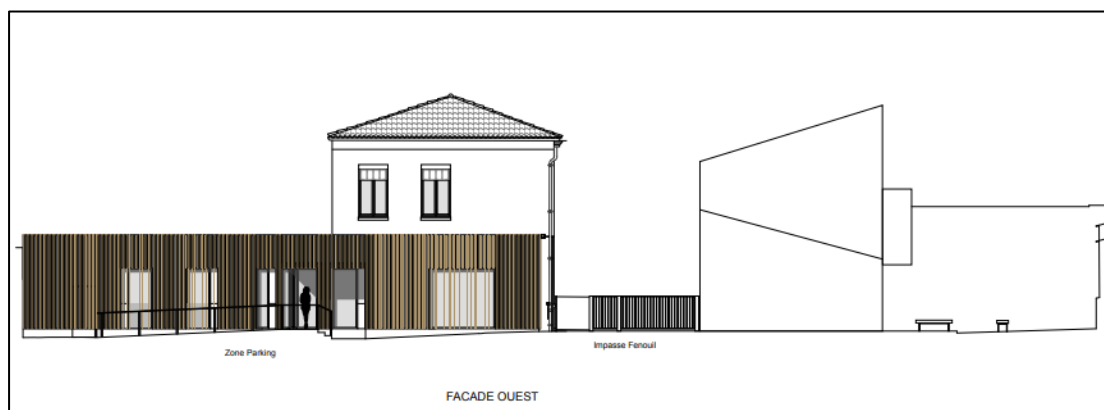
Façade Ouest du projet en zone 1 (bleu)
